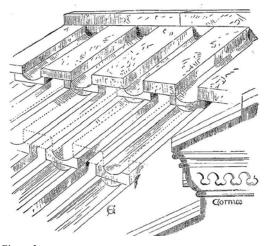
Ávila. Catedral, detalle de las antiguas cubiertas de piedra (Street [1865] 1926)
